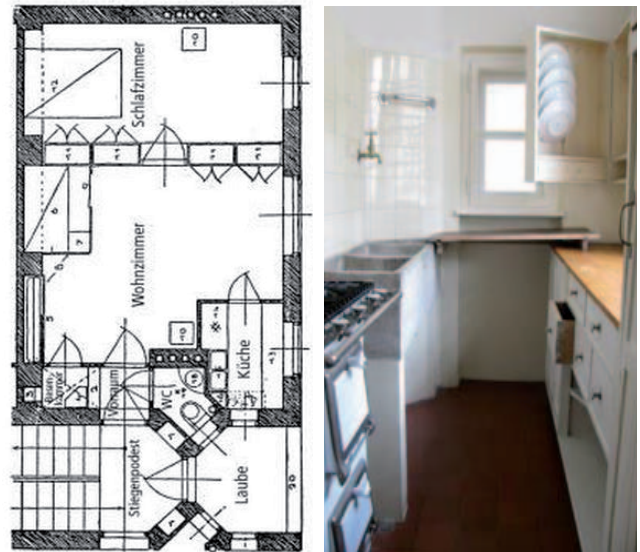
| Grundriss und Küchenansicht der 'Wohnmaschine' 1925
